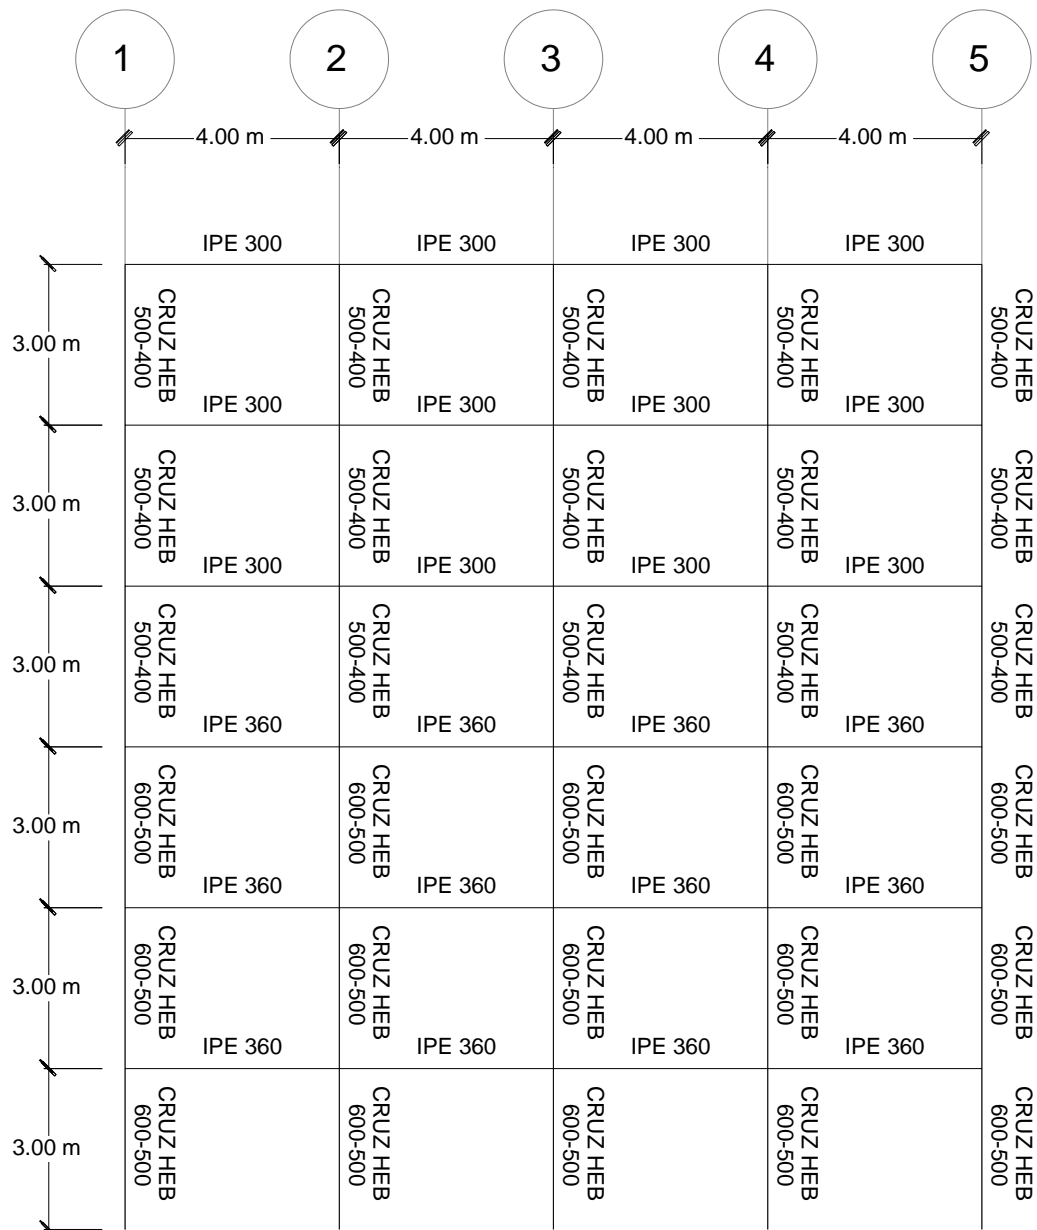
Secciones utilizadas vista en elevación ejes A, B, C, D, E, F, G.
